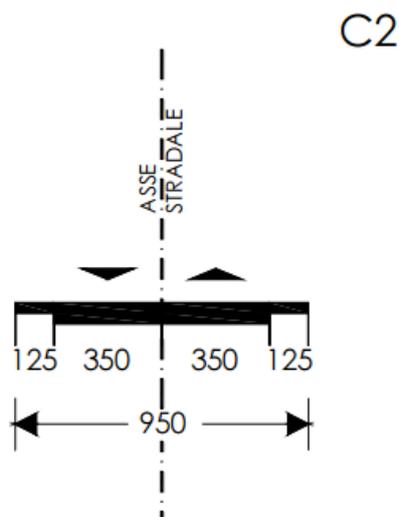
Sezione stradale tipo C2, D.M. 5.11.2001
